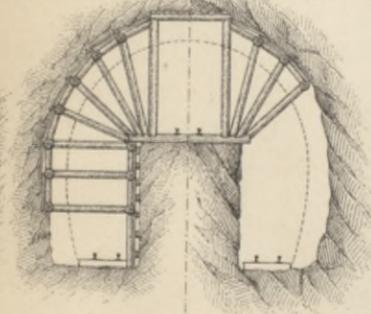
Hönbacher Tunnel. mit Sohlenstollenbetrieb.
